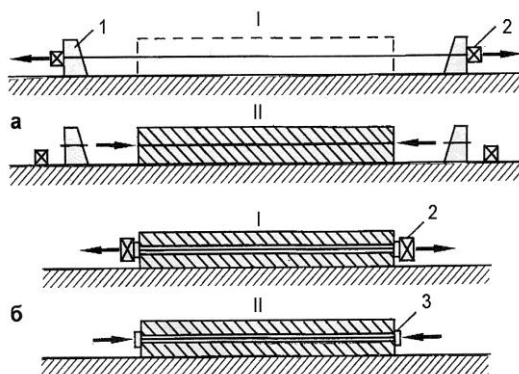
Схемы создания предварительного натяжения арматуры:
